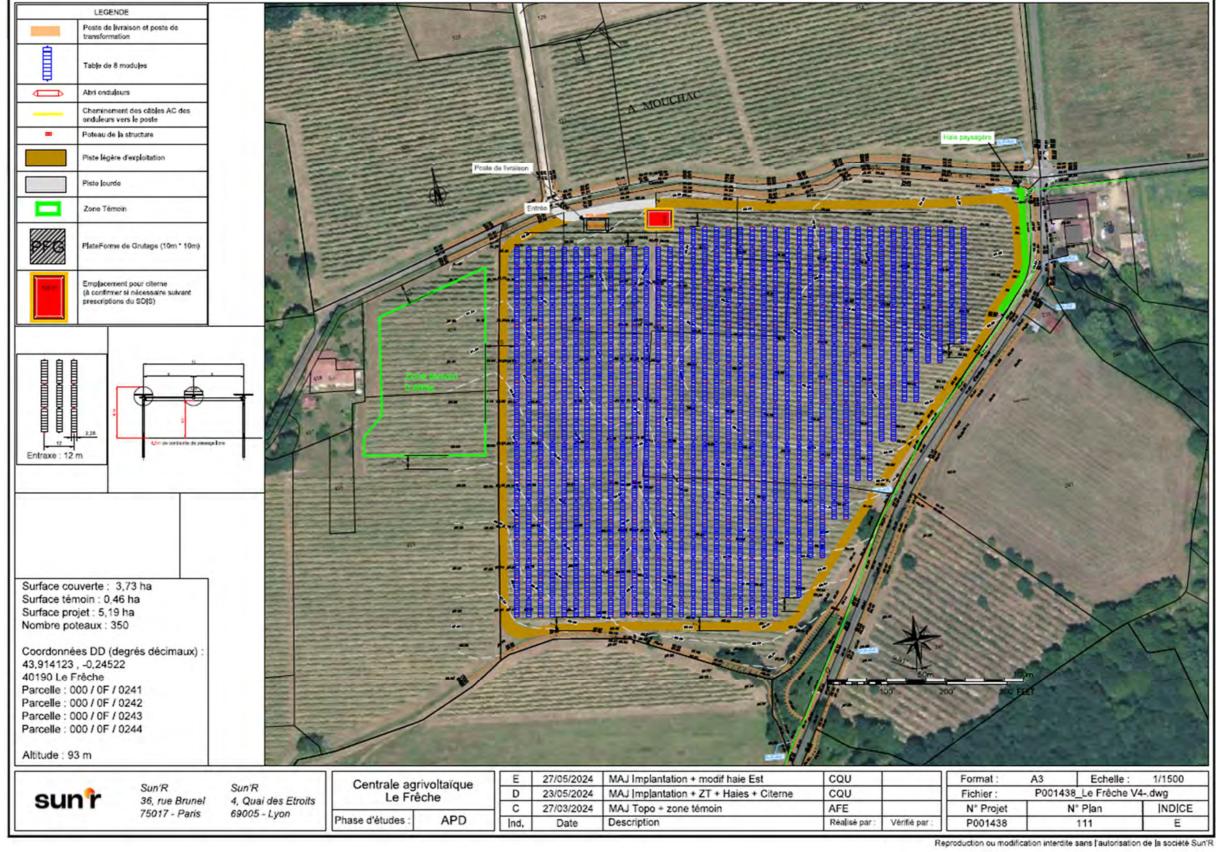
Plan de masse du projet (source : Sun'Agri)
